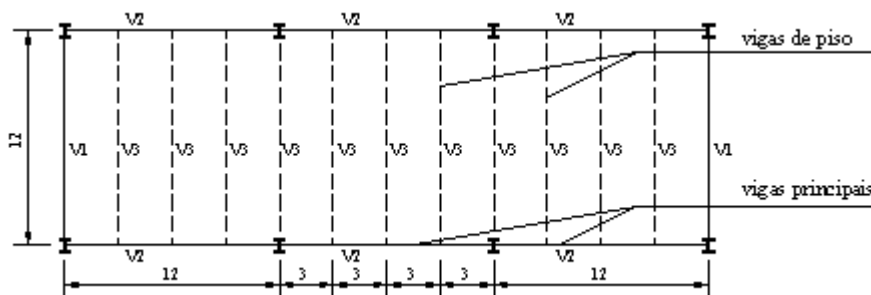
Planta esquemática do vigamento de piso (medidas em m)
